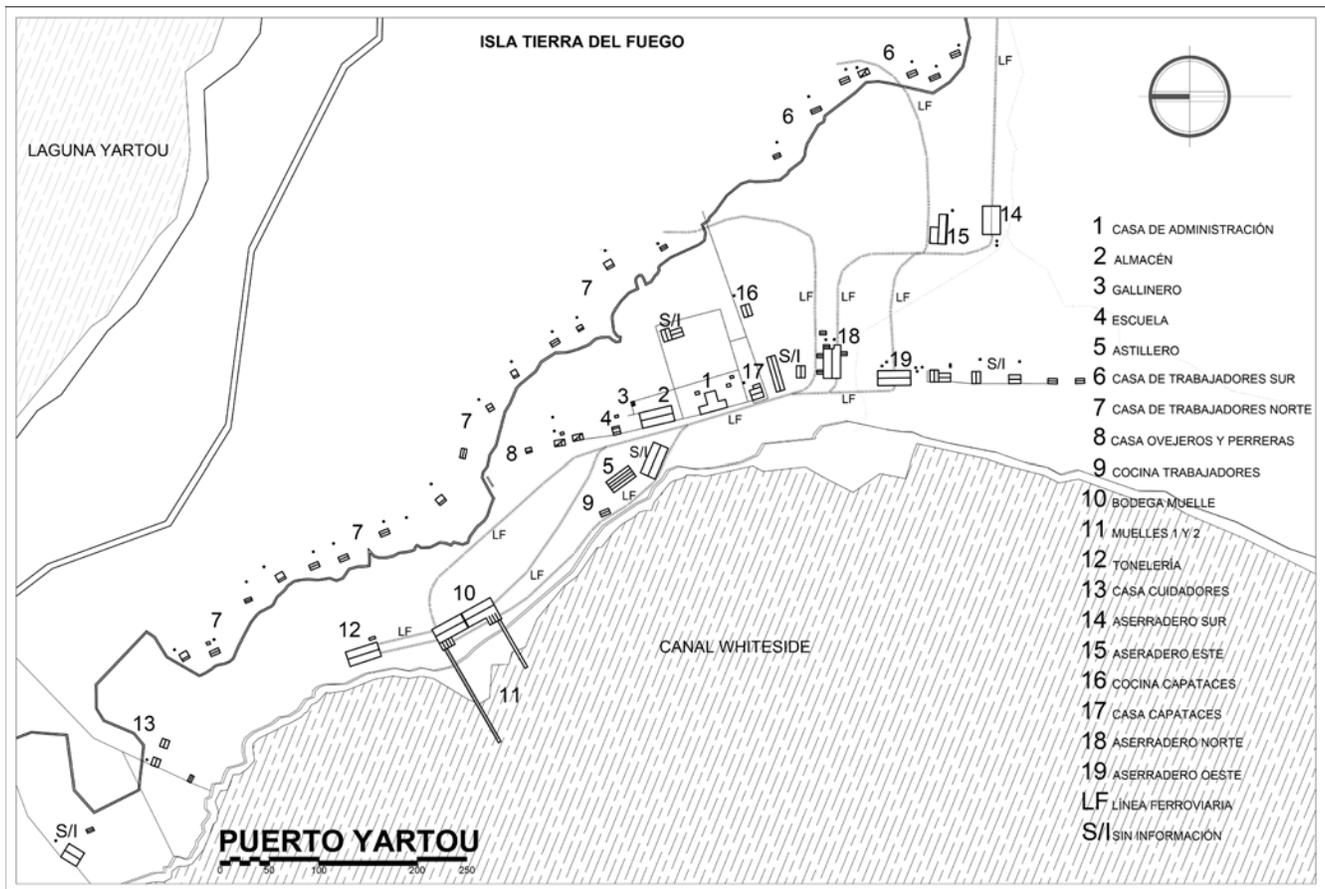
Plano de conjunto aserradero Puerto Yartou.
